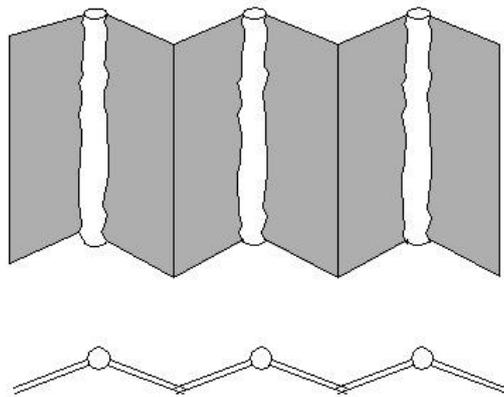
Croquis de barreras delgadas hechas con columnas de jet sin rotación
